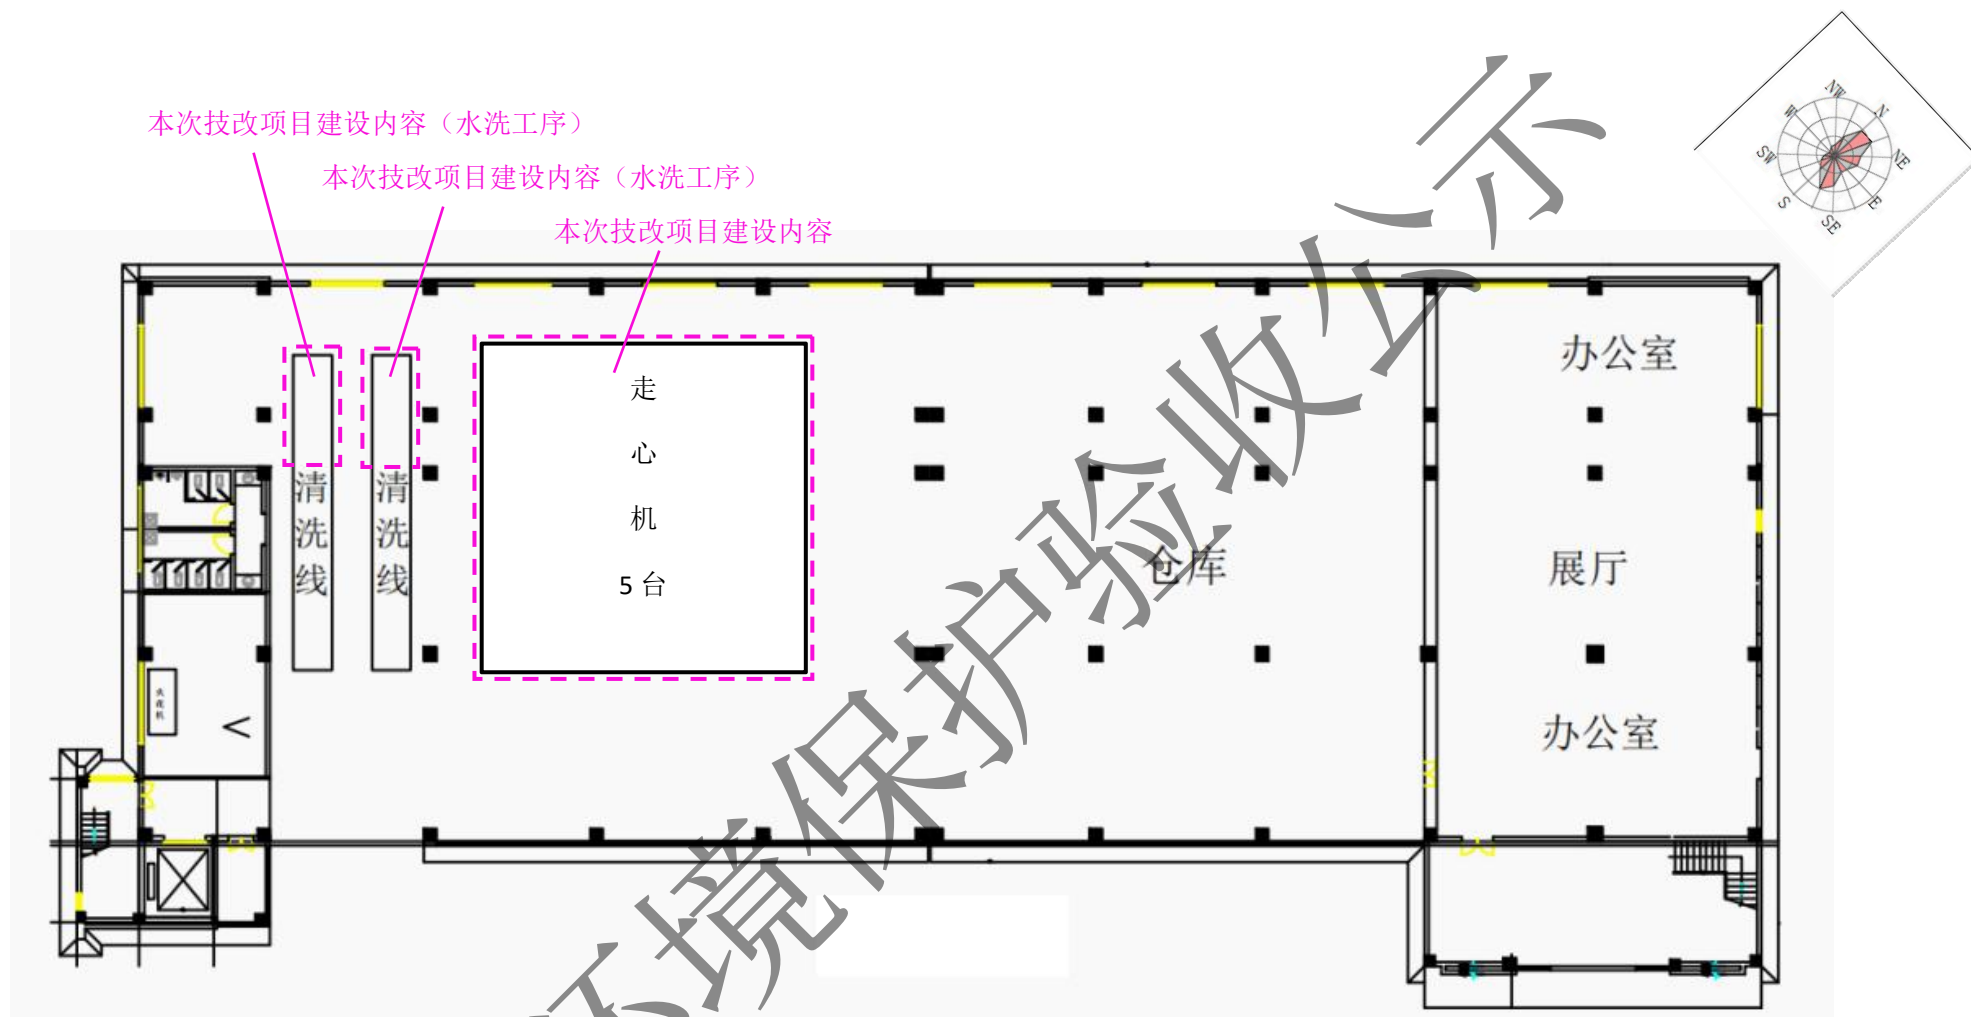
(2) 平面布置图 (1#厂房二层)
